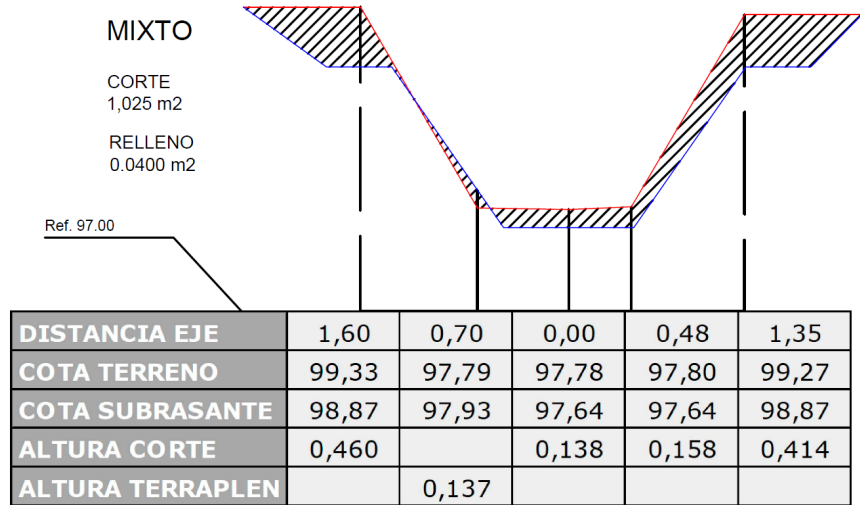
Perfil Transversal N°7 (Fuente Propia)
